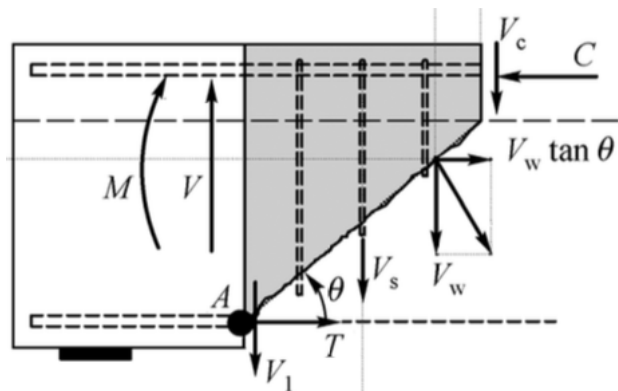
Fuerzas actuantes en una fisura por cortante en una viga [2]
